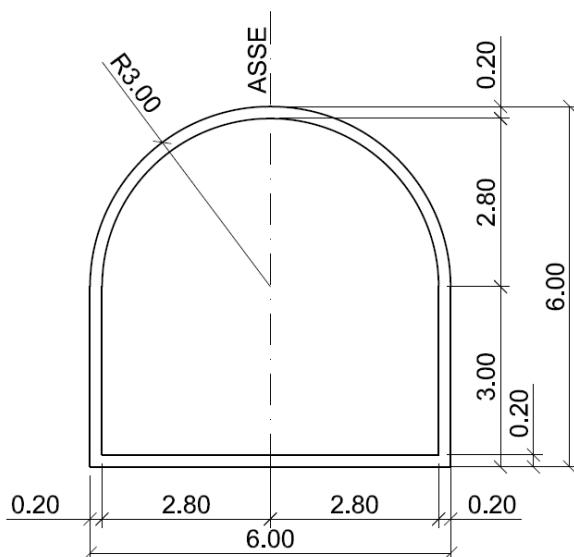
Sezione Analizzata Tipo 2 Galleria Di Accesso Centrale E Pozzo Piezometrico Di Valle
